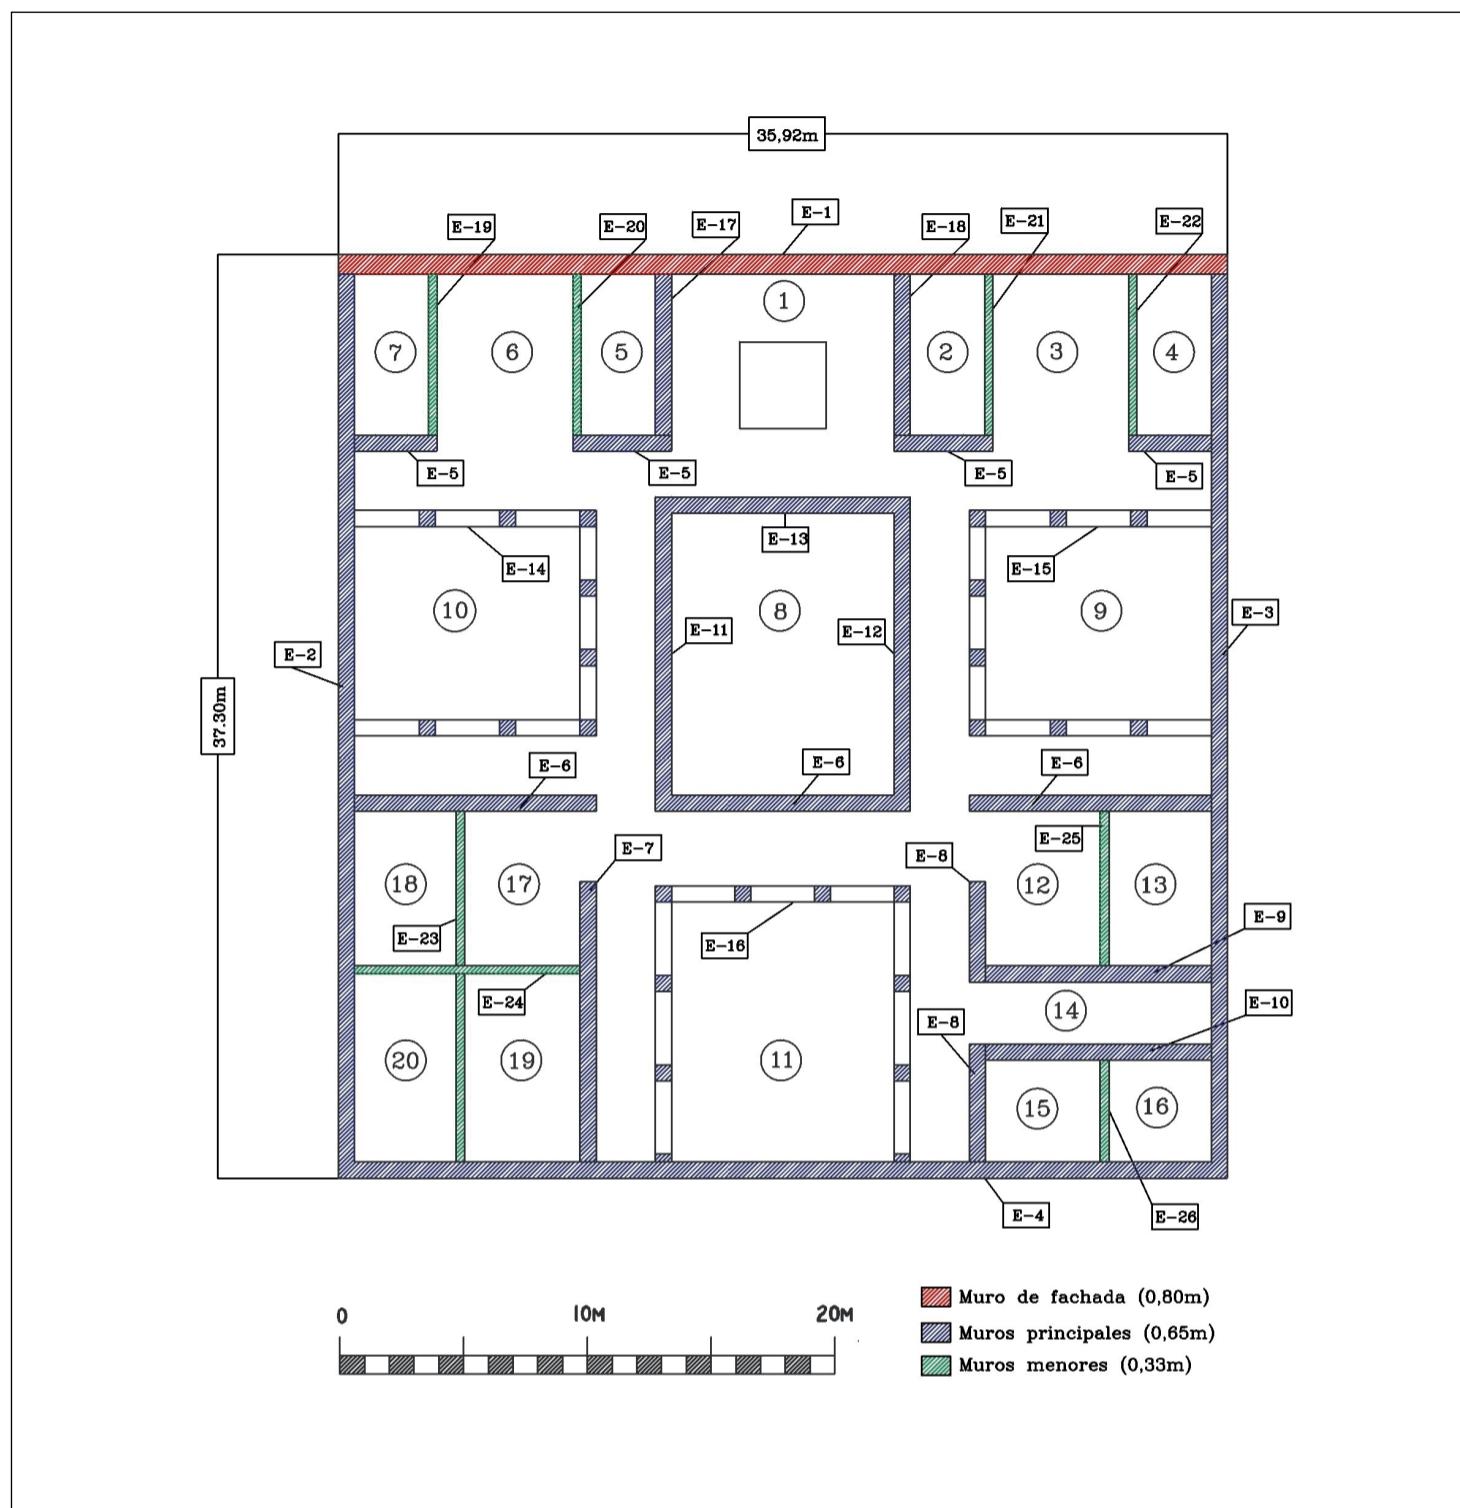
Plano de la Casa Palacio escalado y rectificado con la identificación de estructuras y medidas reflejadas en el manuscrito (De los Ríos, 1879). Elaboración propia.
